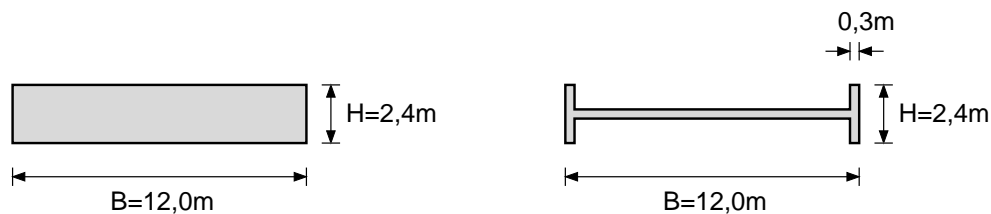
Der R- (links) und H-Querschnitt (rechts), Querschnitt mit Abmessungen
